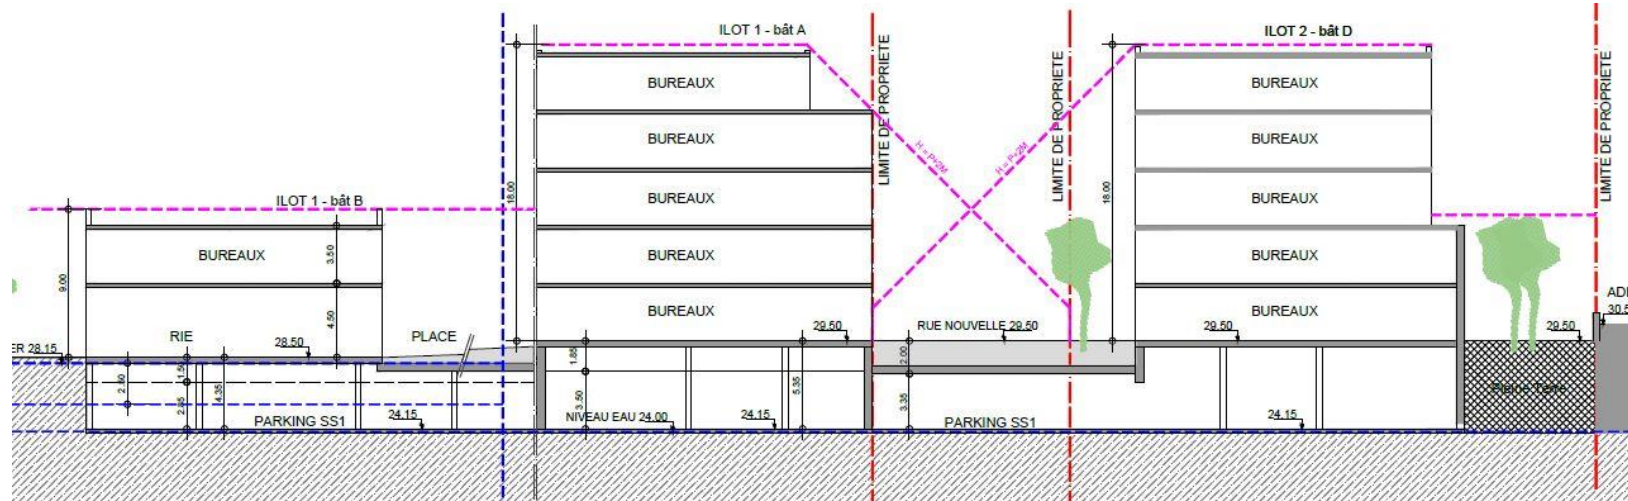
Coupe longitudinale des bâtiments A, B et D (source : CALQ, avril 2020)
